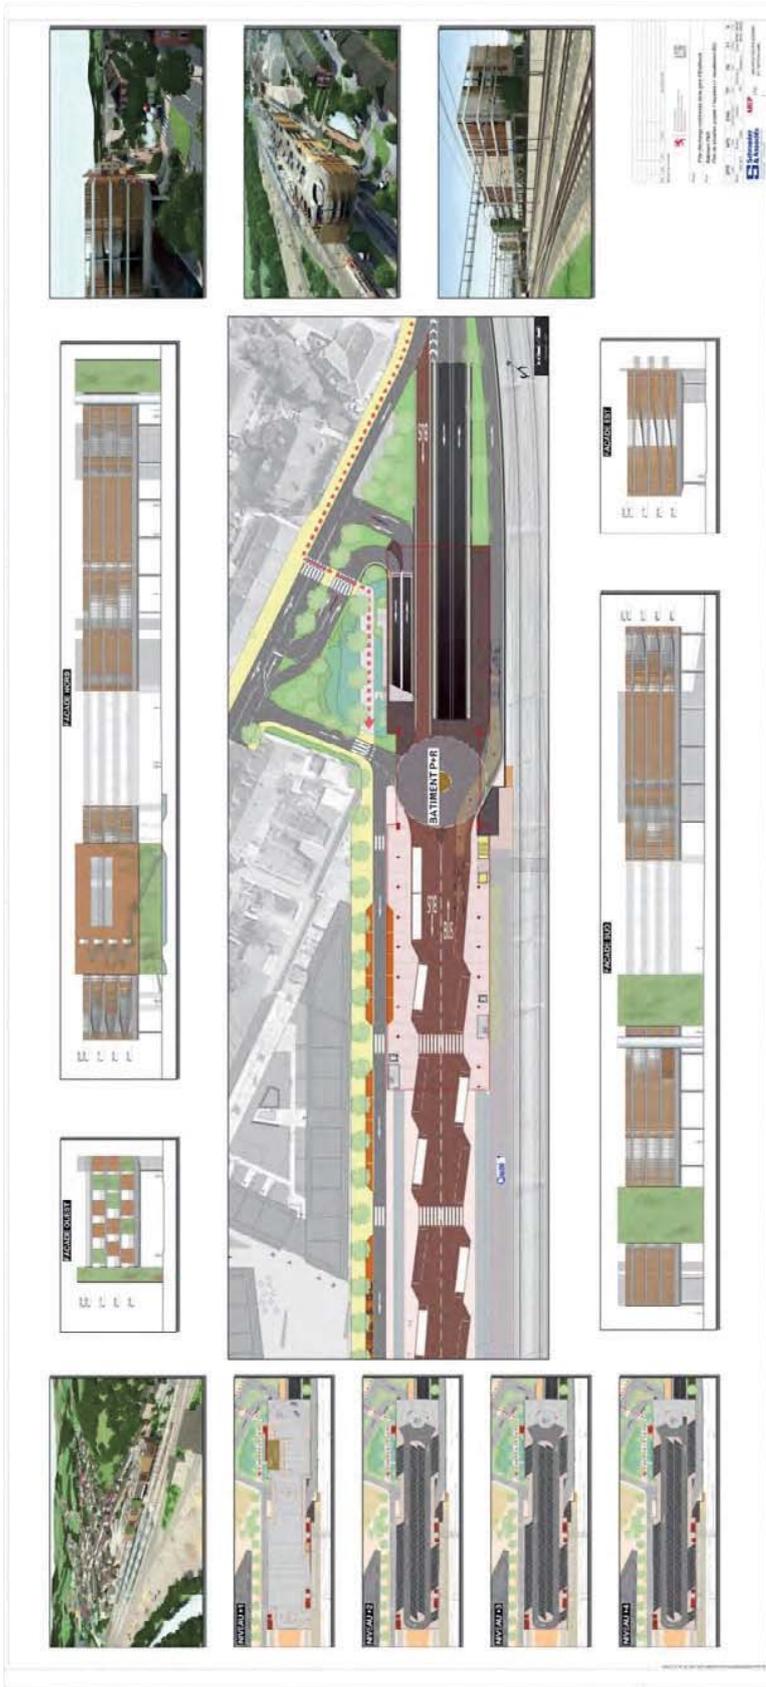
Bâtiment P&R – plan de situation projeté/façades & visualisations 3D
